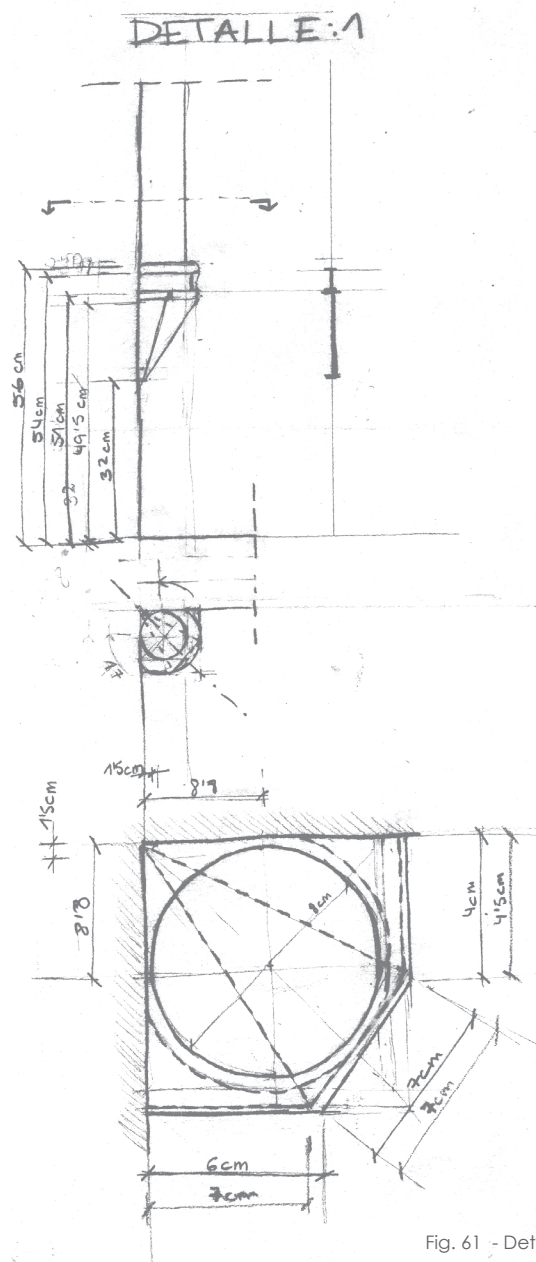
Detalle arranque de la columnilla inferior izquierda.
